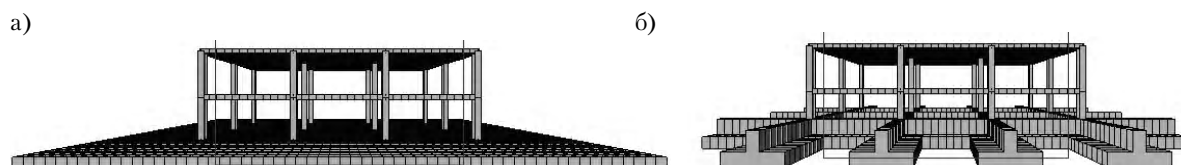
Виды фундаментов на деформируемых территориях (противокарстовые фундаменты) [13]: а) в виде сплошной плиты; б) в виде системы перекрестных балок.
